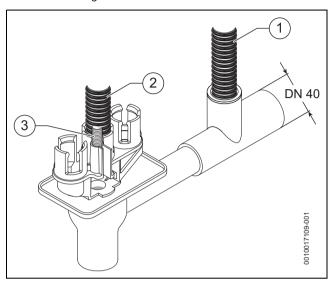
Instalar los tubos de descarga en el accesorio de conexión 432
